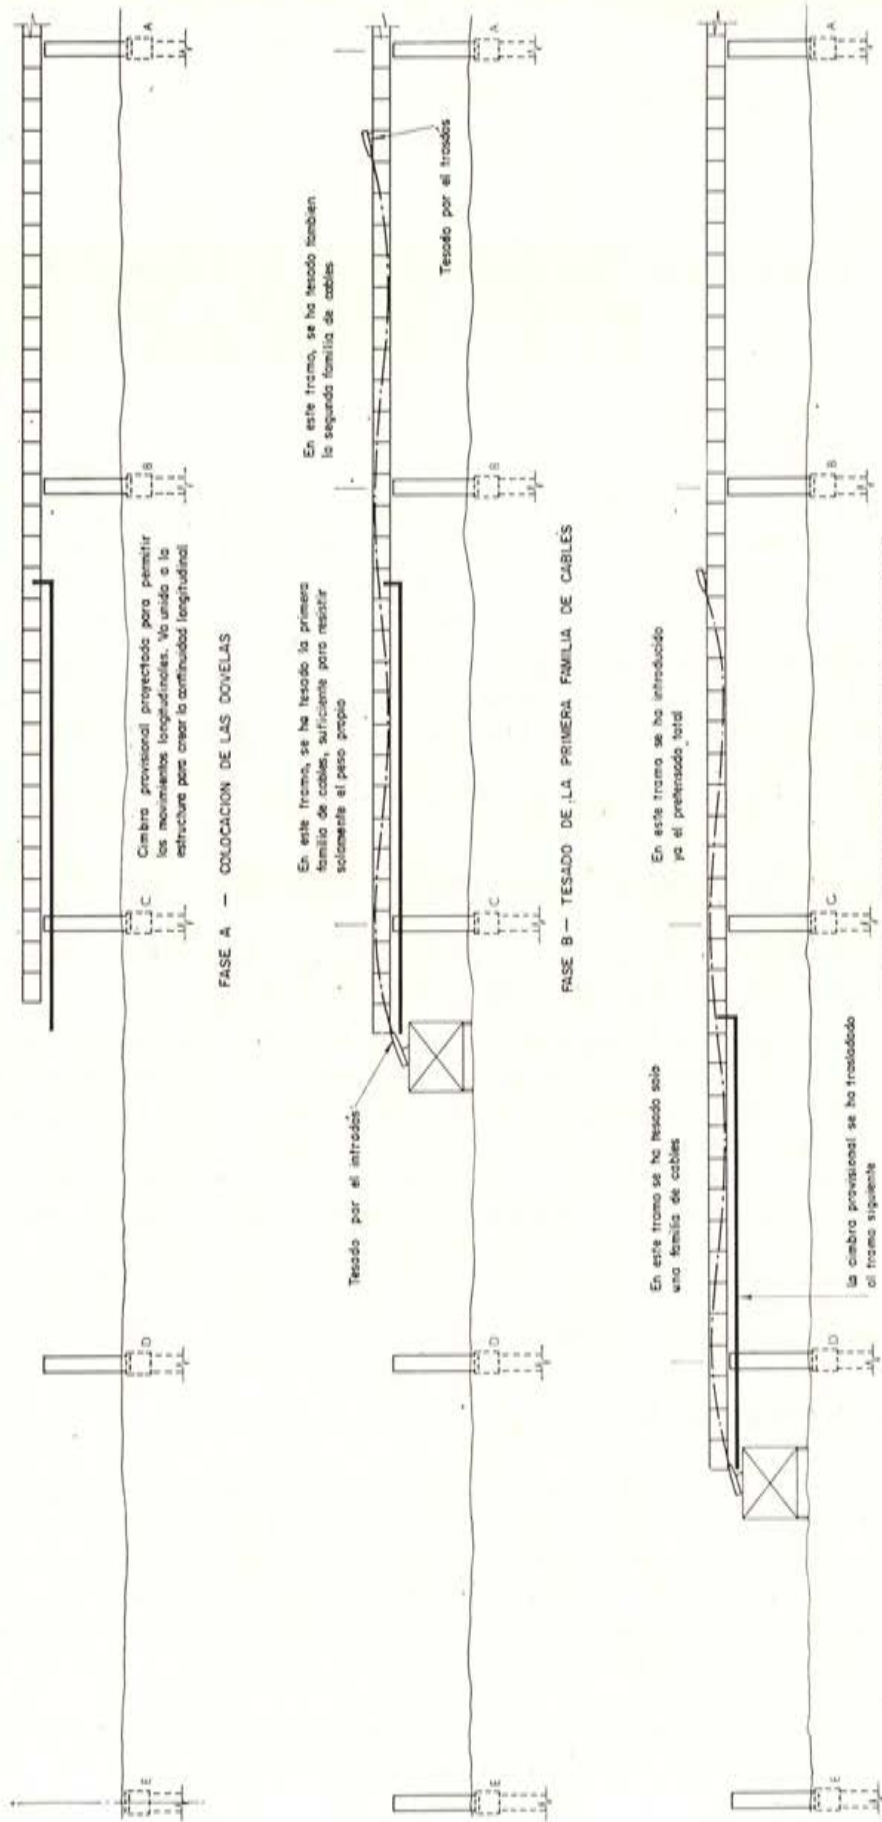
Paso elevado de Mancunian Way, en Manchester. Proceso constructivo.
